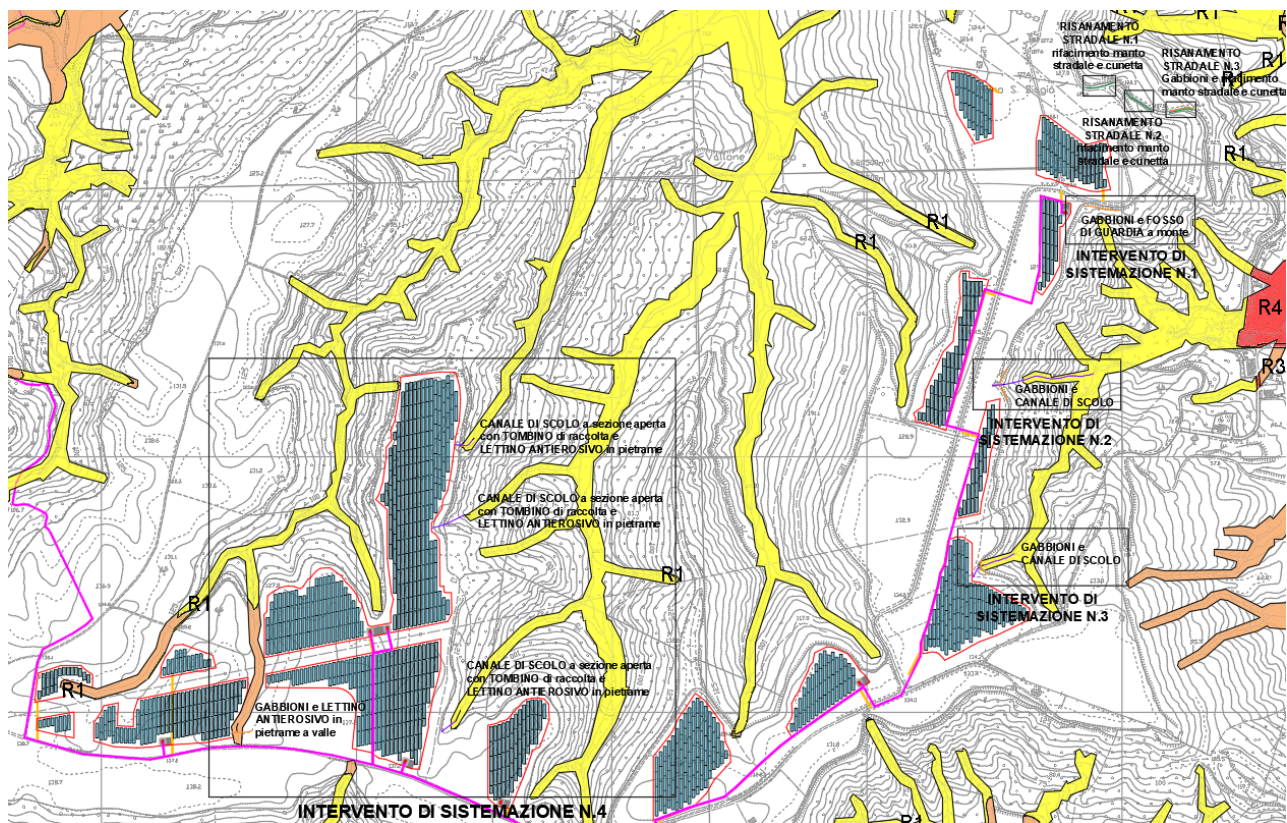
Distanza delle opere di mitigazione dalle aree del PGRA – Rischio alluvioni
